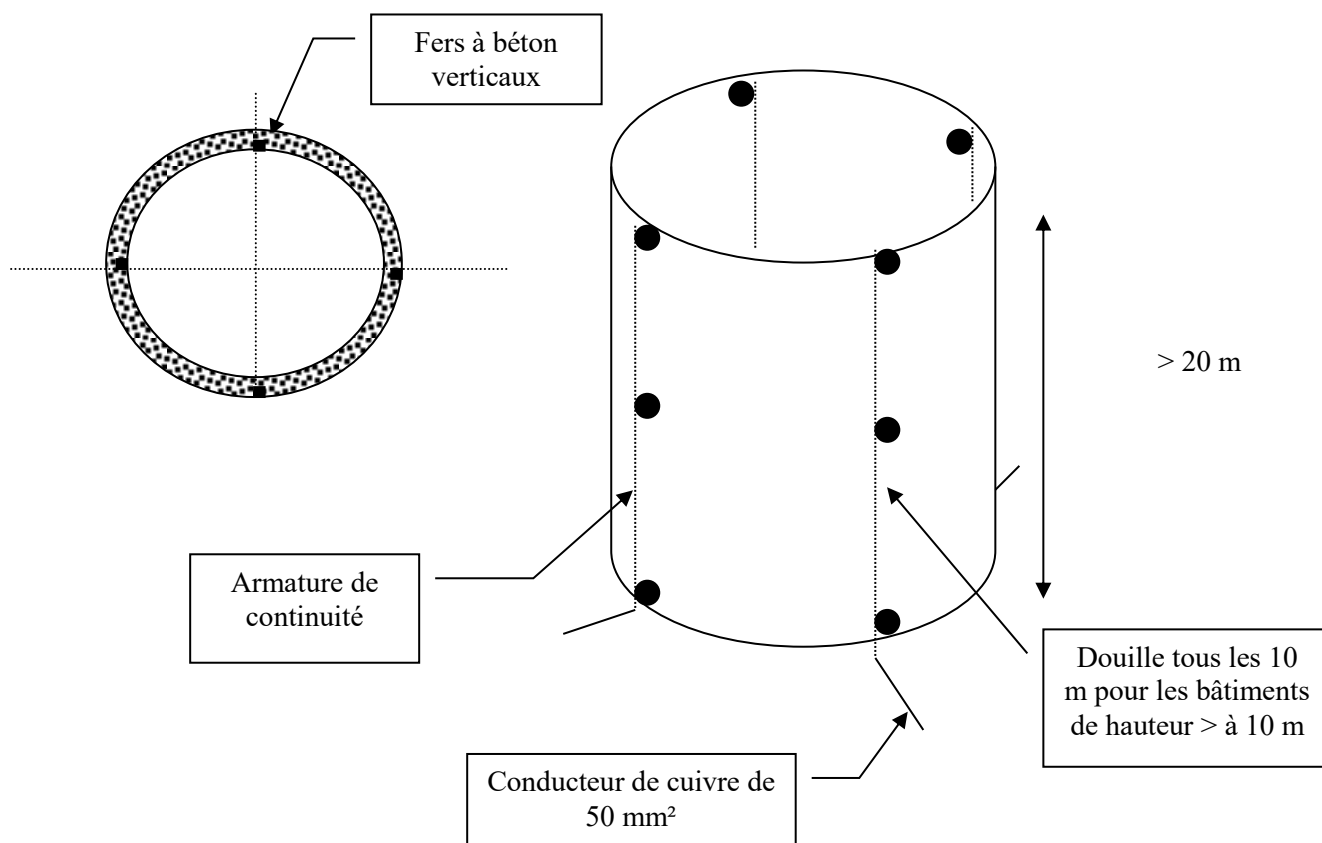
Disposition des douilles sur un bâtiment circulaire.
